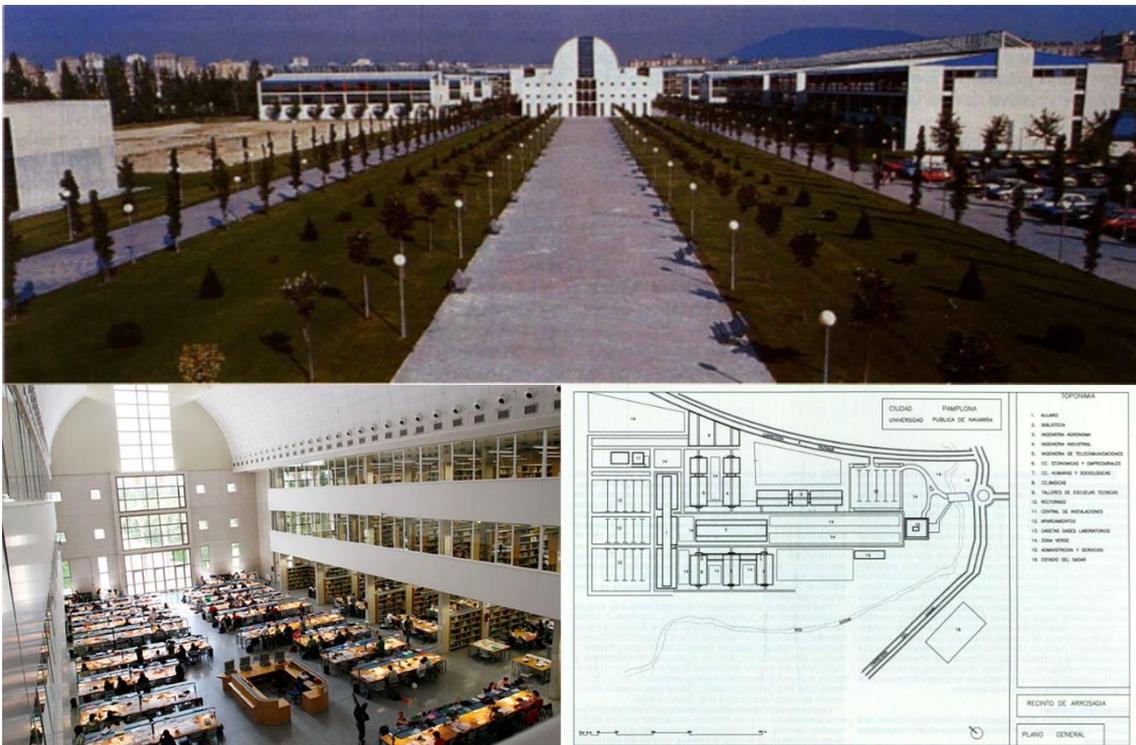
Fachada, interior y plano del campus de la Arrosadía.
